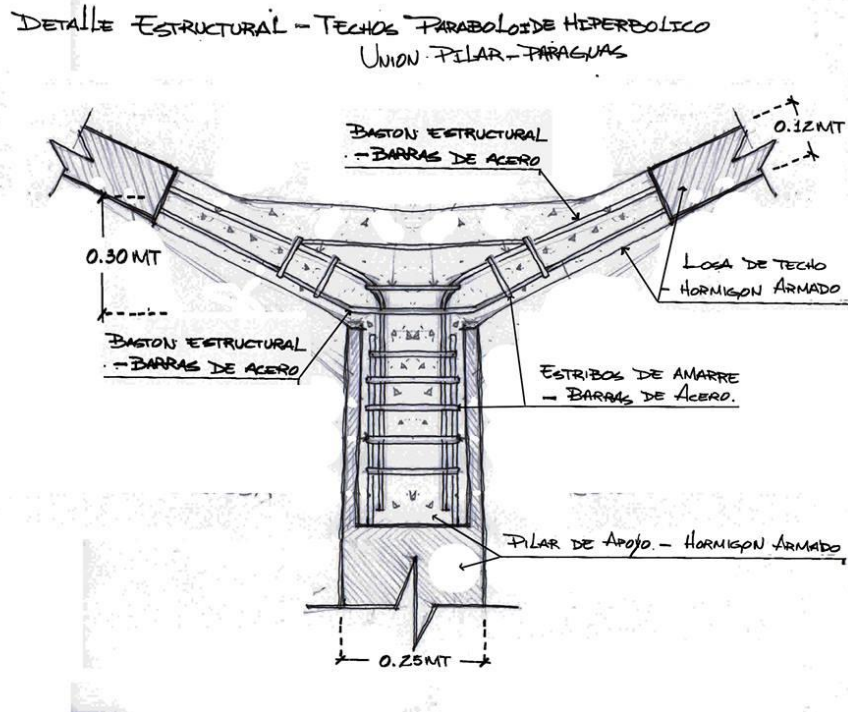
Detalle de Unión de Columnas de soporte al paraboloide. Elaboración Propia
